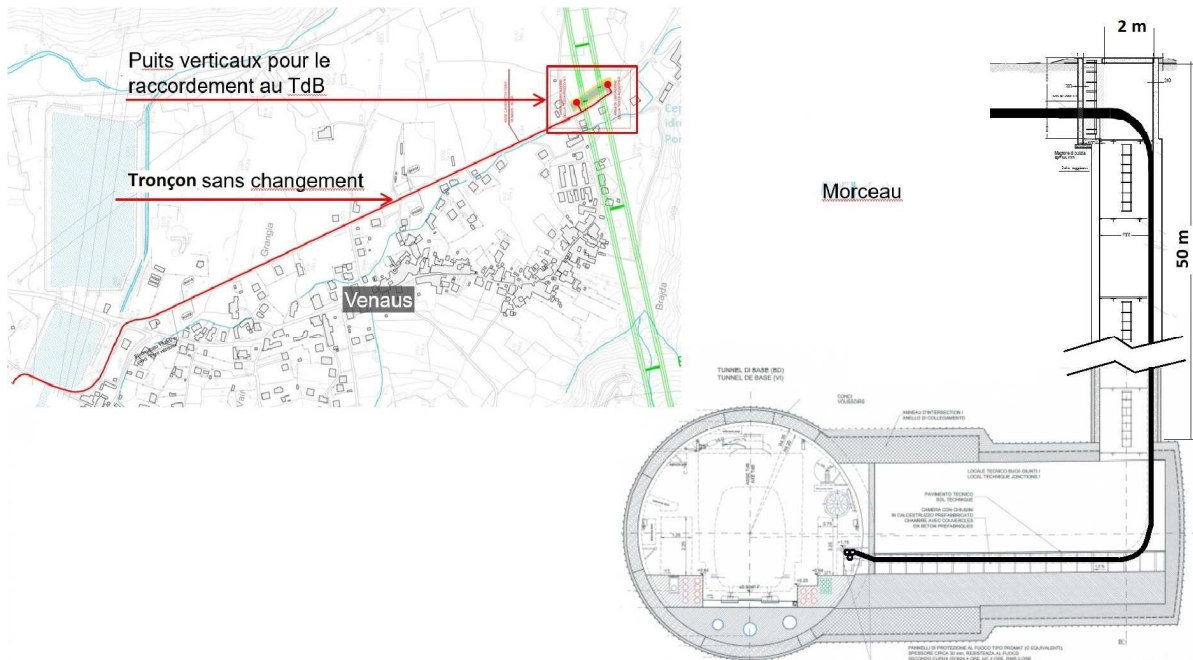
Secteur initial du tracé et section d'un puits de descente vers le tunnel de base
